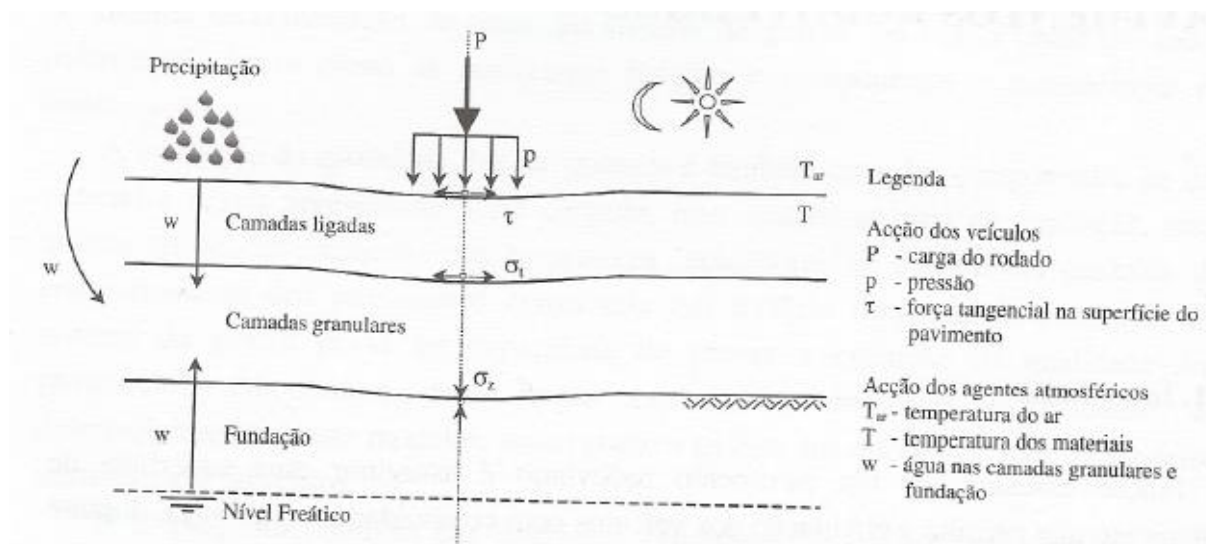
Pavimento rodoviário: constituição e ações (adaptado de Branco et al., 2011)
